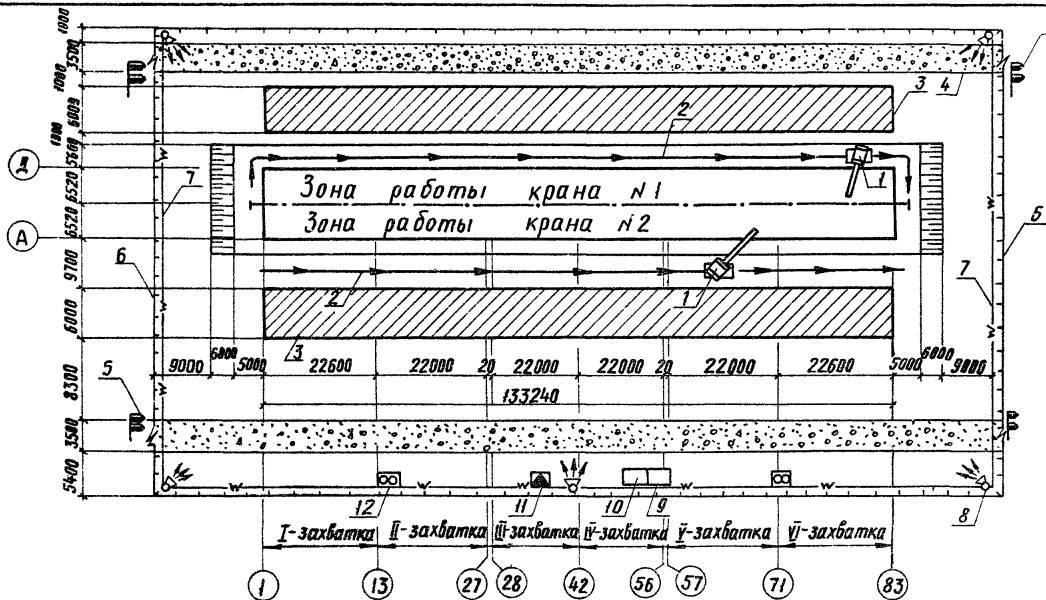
Рис. I. Схема организации строительной площадки: I-краны К-161; 2-оси прохода кранов; 3-площадки складирования материалов и конструкций; 4-временный проезд; 5-знаки: "Берегись автомобиля" и "Посторонним вход воспрещен"; 6-временное ограждение; 7-кабель 380в; 8-проекторная мачта; 9-бытовое помещение; 10-контора производителя работ; 11-трансформаторная подстанция КТПН-180; 12-туалет
